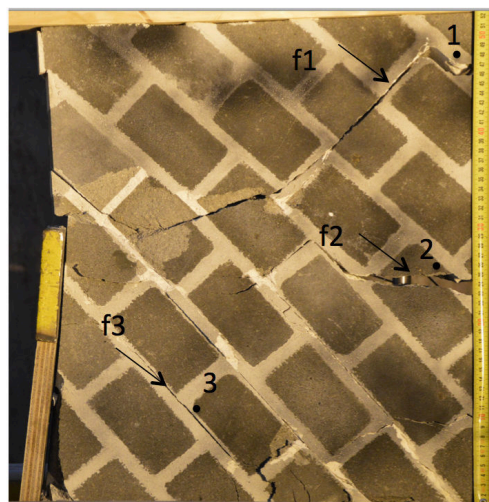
Fissurations observées à la fin de l'essai (f1, f2 et f3)
